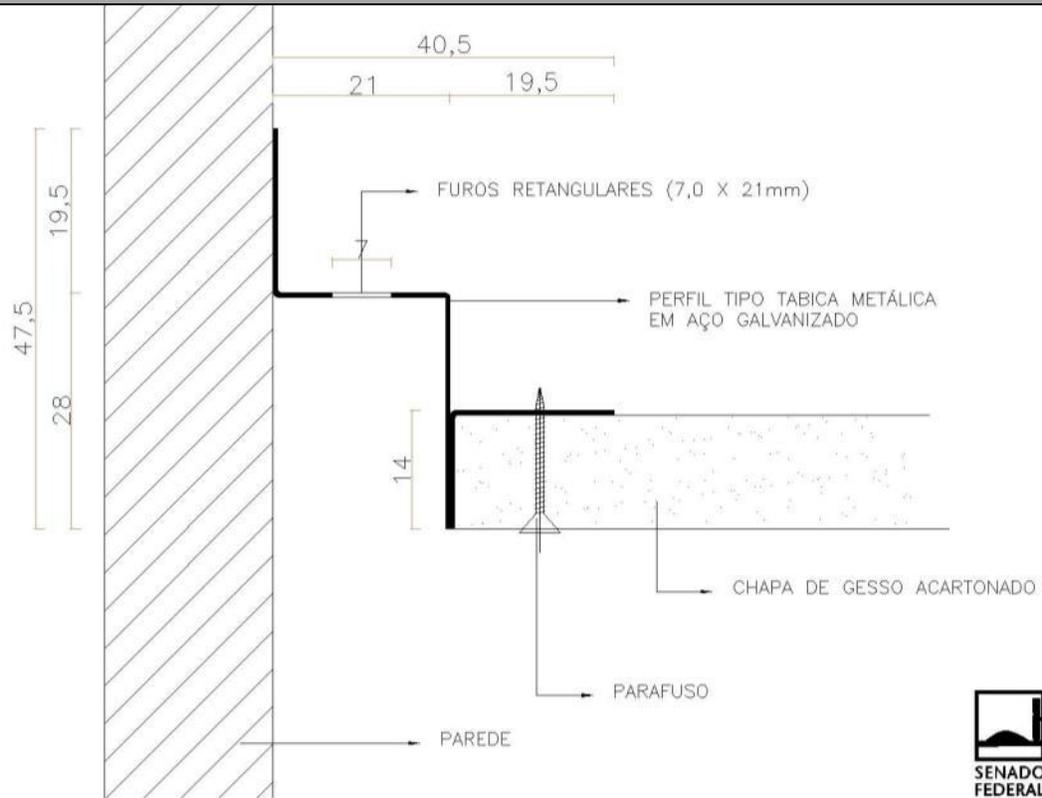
Detalhe da instalação de tabica em perfil metálico.
